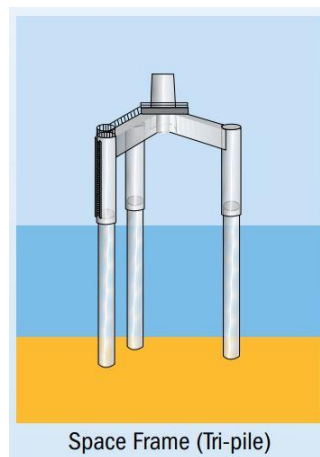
Estructura tripilote. Fuente: Informe “Deep Water”, EWEA
